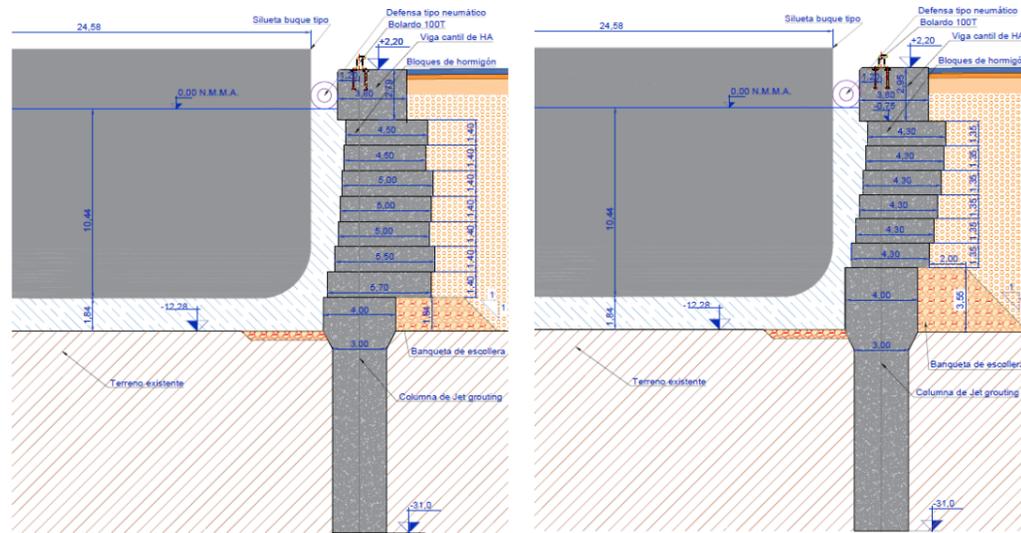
Alternativa 1: Columna de Jet grouting, Tramo 1 (izq.) y Tramo 2 (dcha.).
